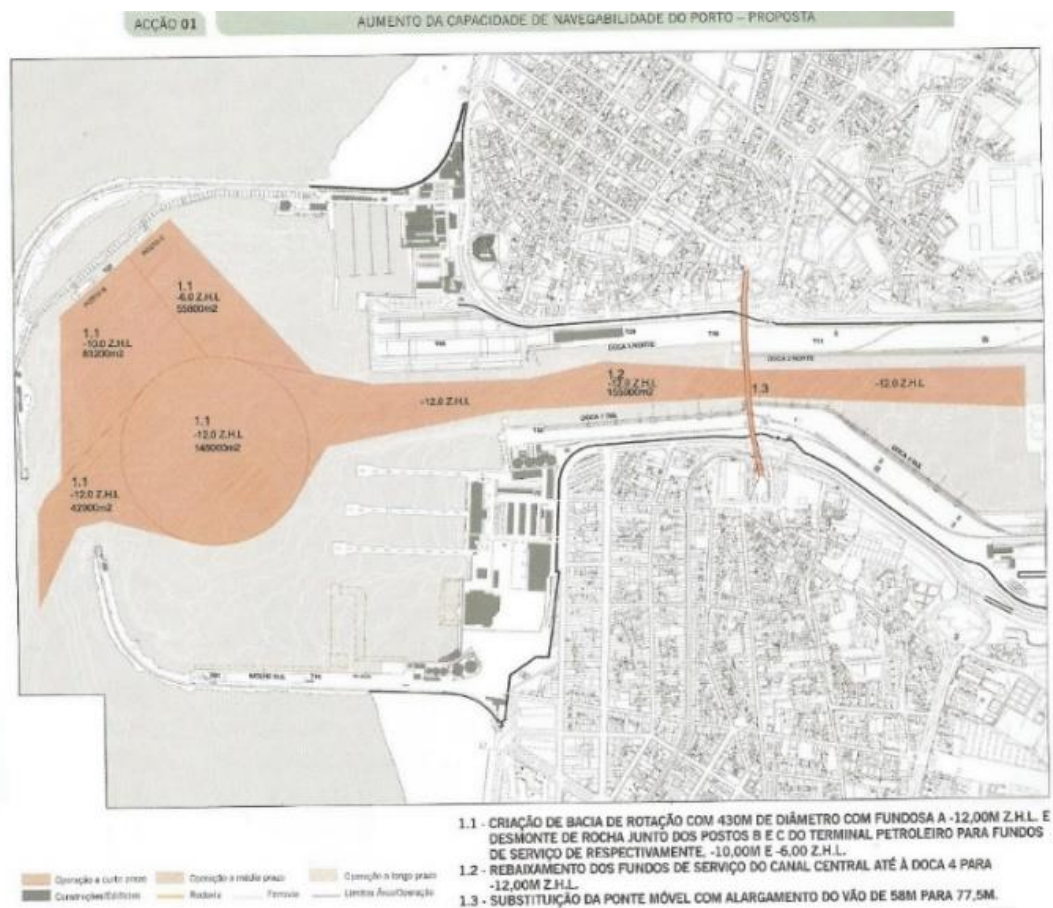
Planta da ação 01 – Fonte: Adaptado APDL, 2006
